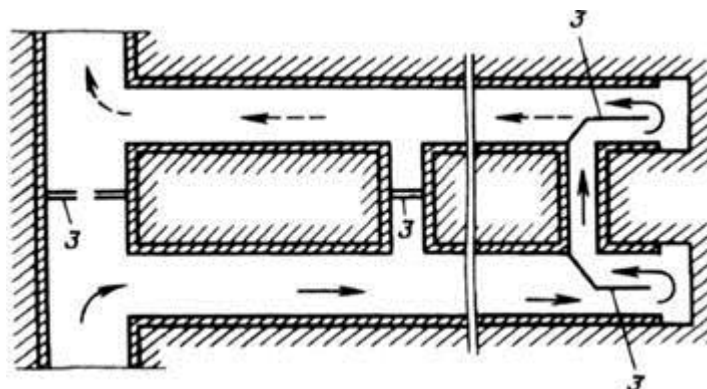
Способ проветривания с использованием параллельной выработки: 1 – ВМП; 2 – вентиляционный трубопровод; 3 – вентиляционная переключательная перемычка
